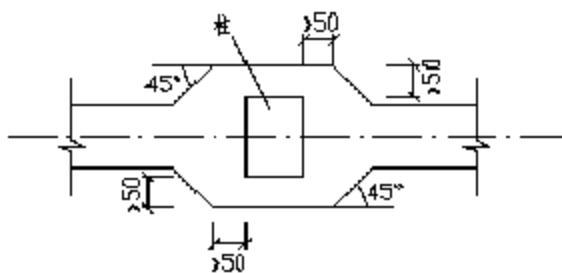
现浇柱与条形基础肋梁连接处的平面尺寸
